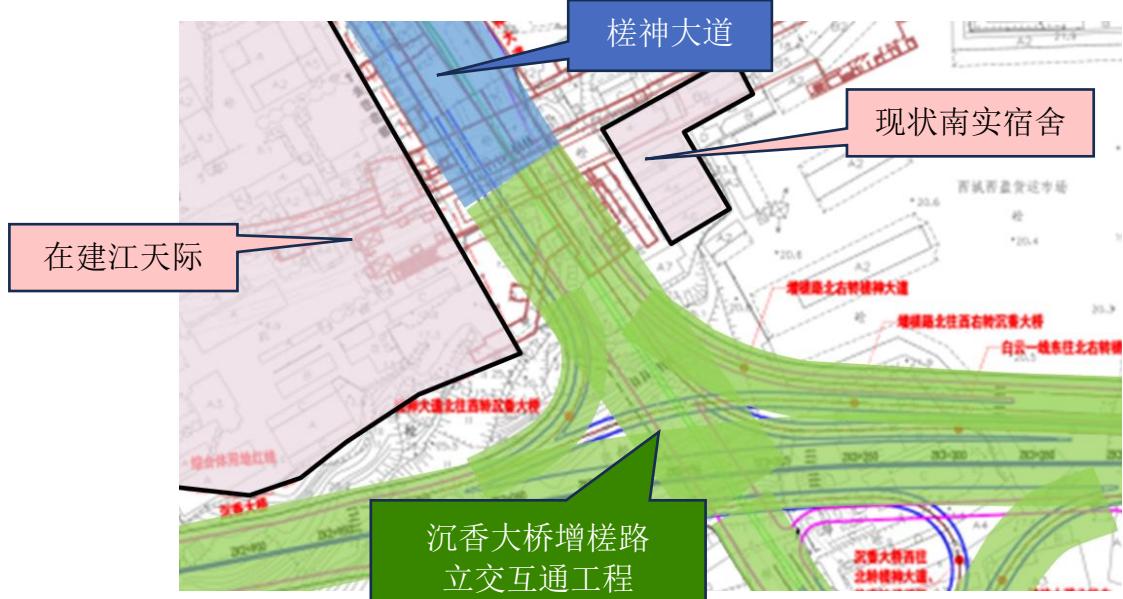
沉香大桥增槎路立交互通平面布置图
